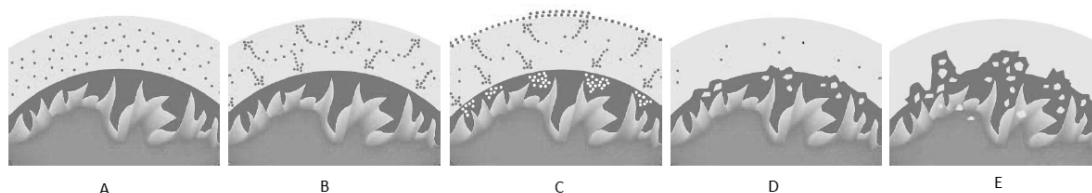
Proceso de spalling (fuente: www.concretebasics.org)
